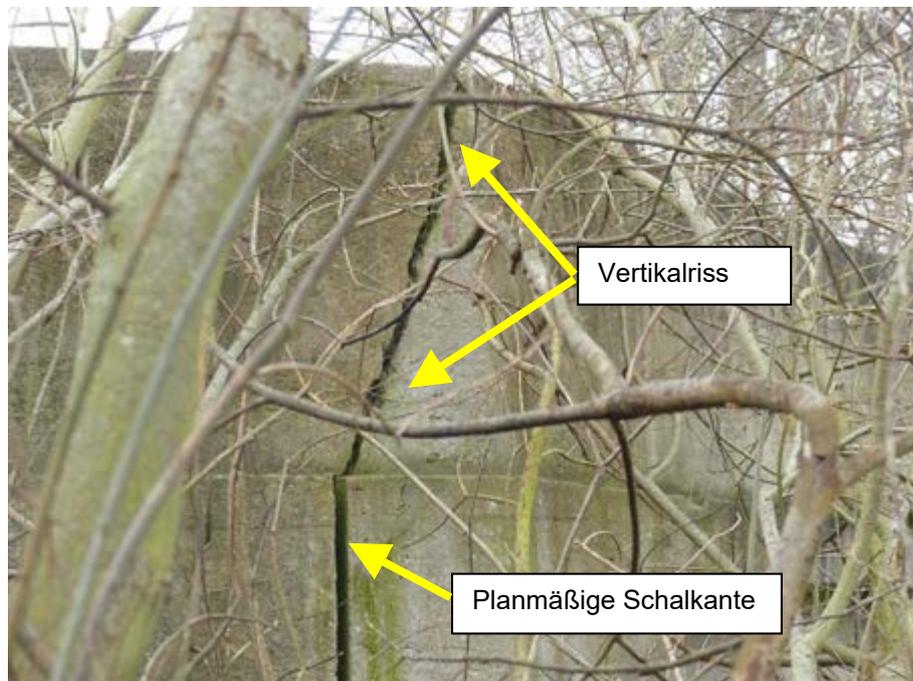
Planmäßige Schalkante und unplanmäßiger Vertikalriss
